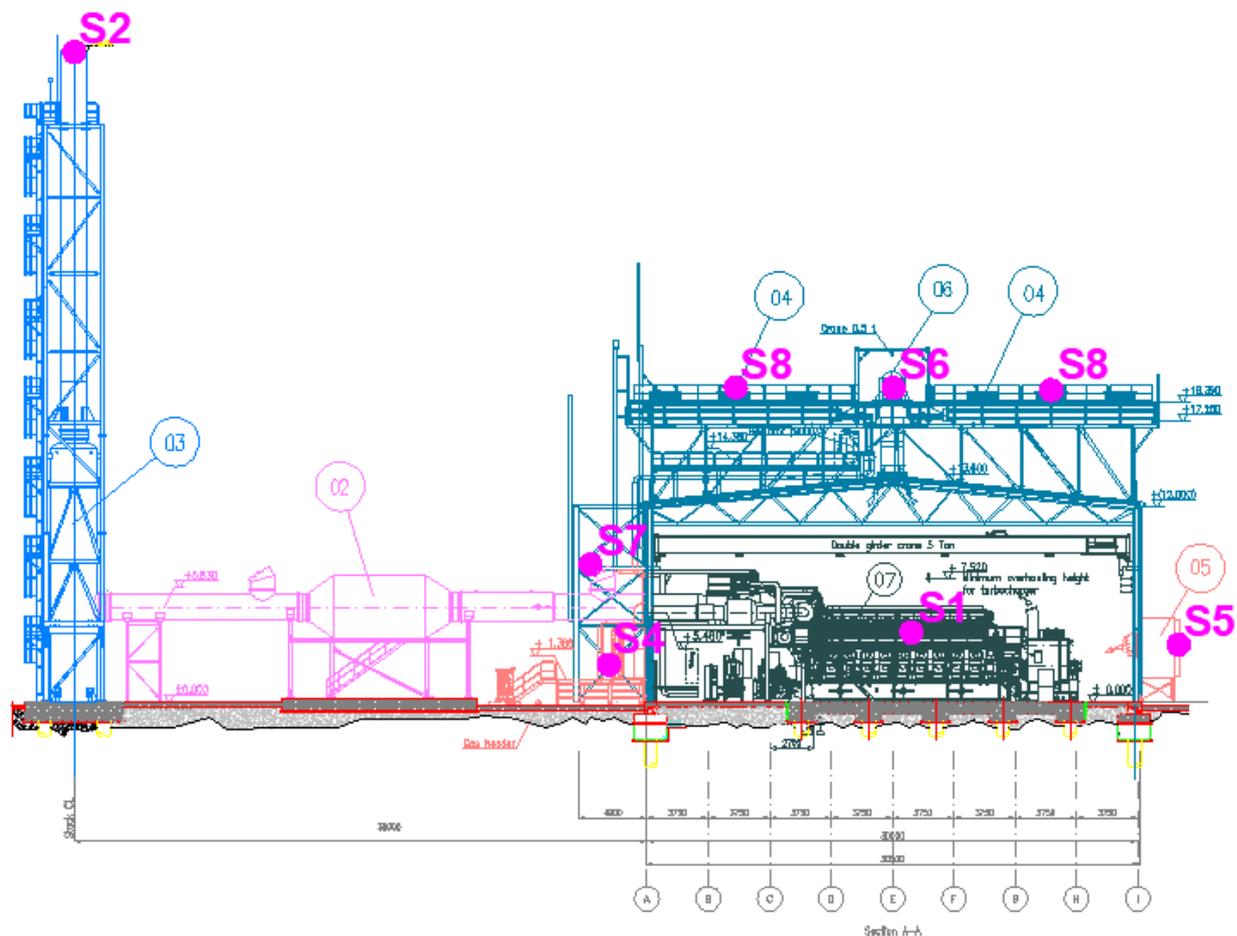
Planimetria e sezione con disposizione delle sorgenti sonore
